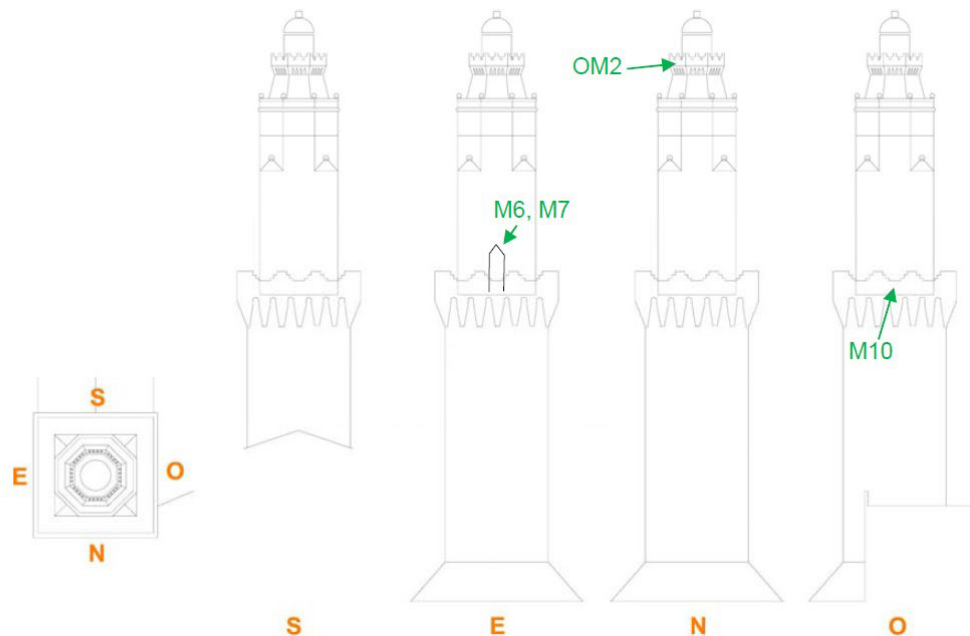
Esquema en planta y sobre alzados, donde se localizan los puntos de extracción de las muestras de mortero, recogidas en el Faro de Portopí.
